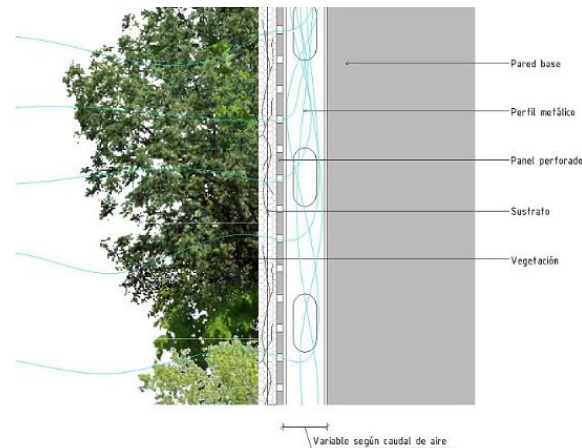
Detalle constructivo de Sistema de ventilación con pared vegetal.
